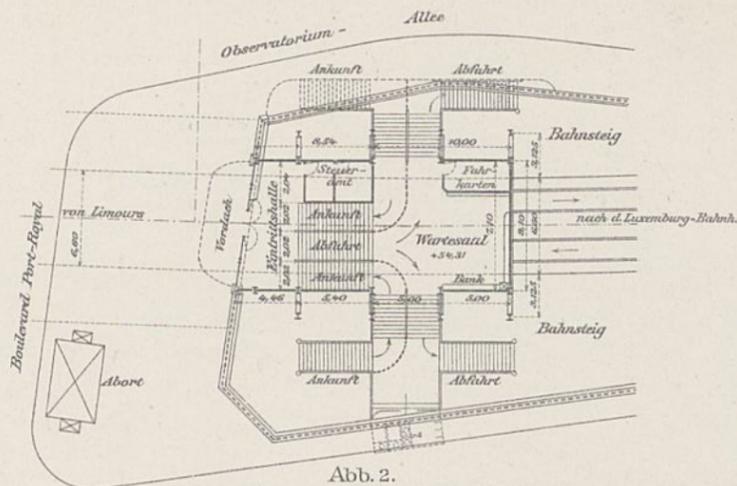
Grundriss der Port-Royal-Station. 1:500.
